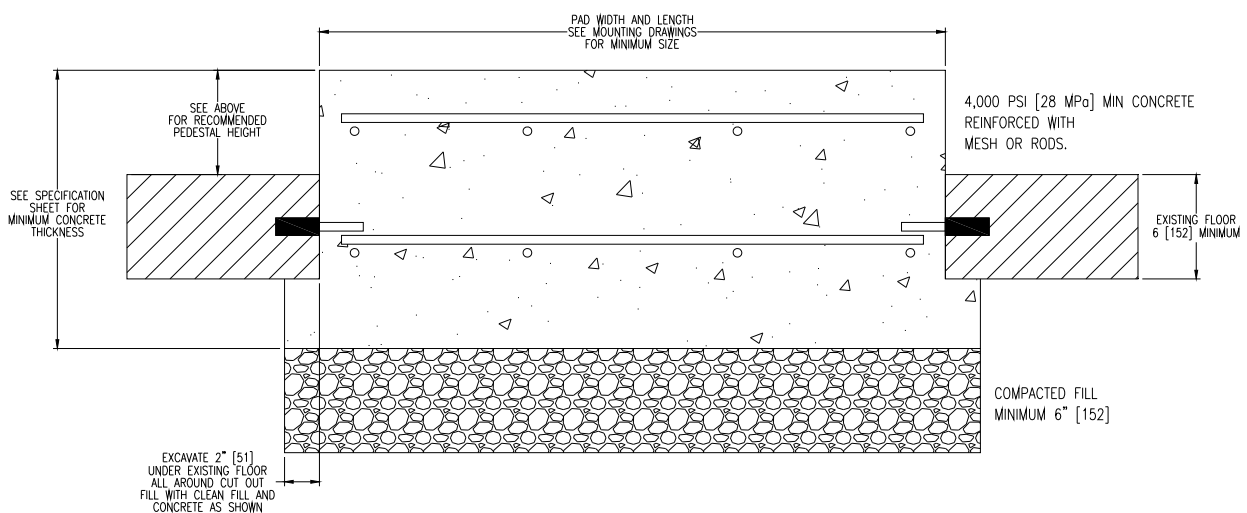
Nuova base rialzata in calcestruzzo fissata al pavimento esistente
